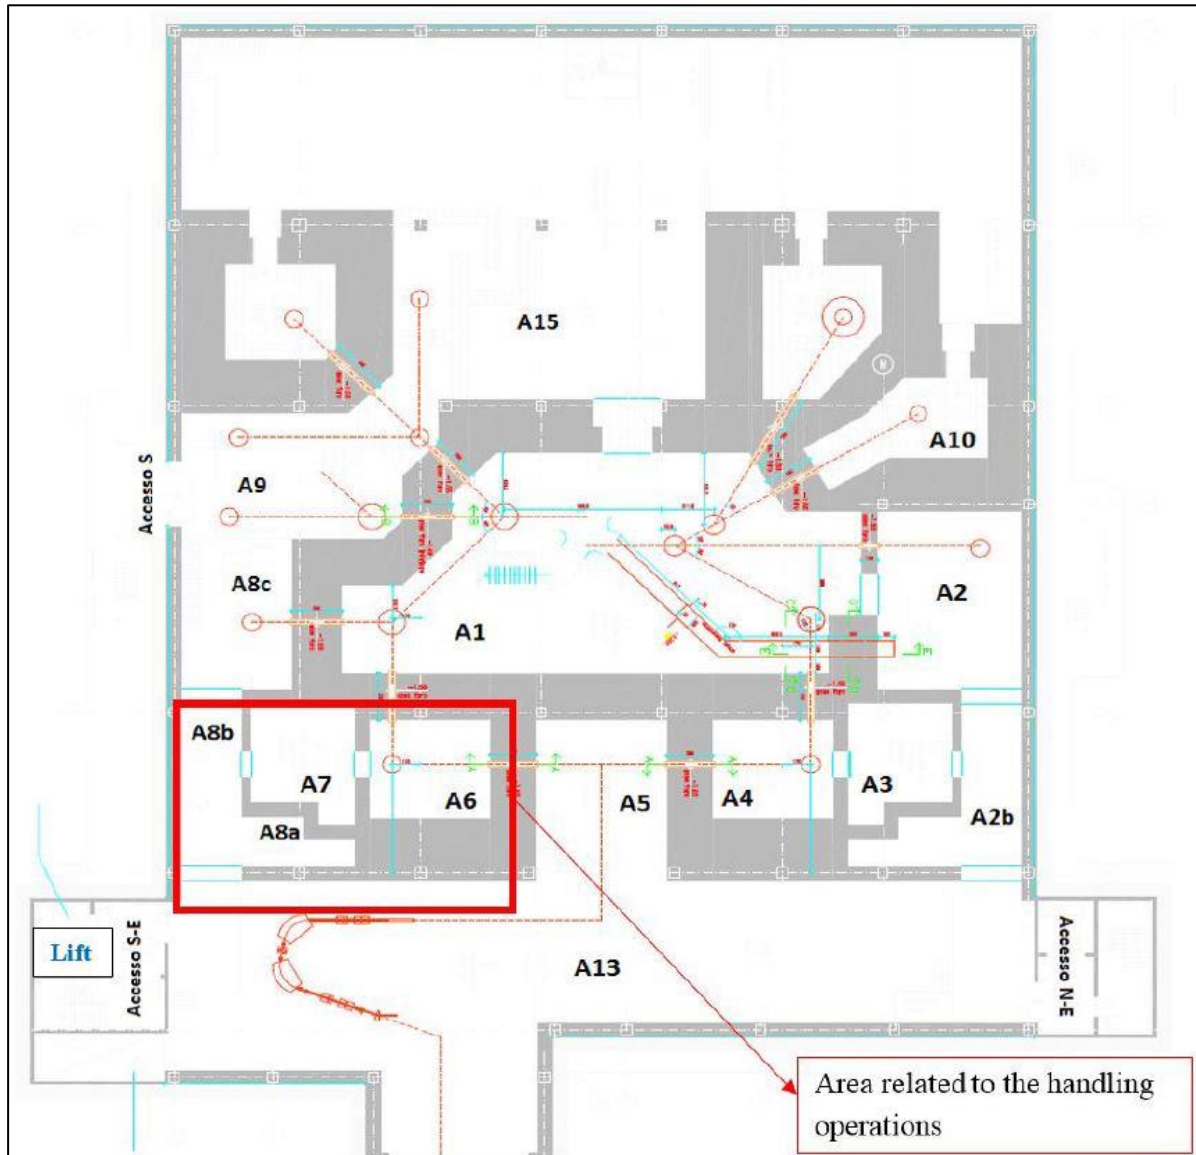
Planimetria del piano interrato dell'edificio SPES.
